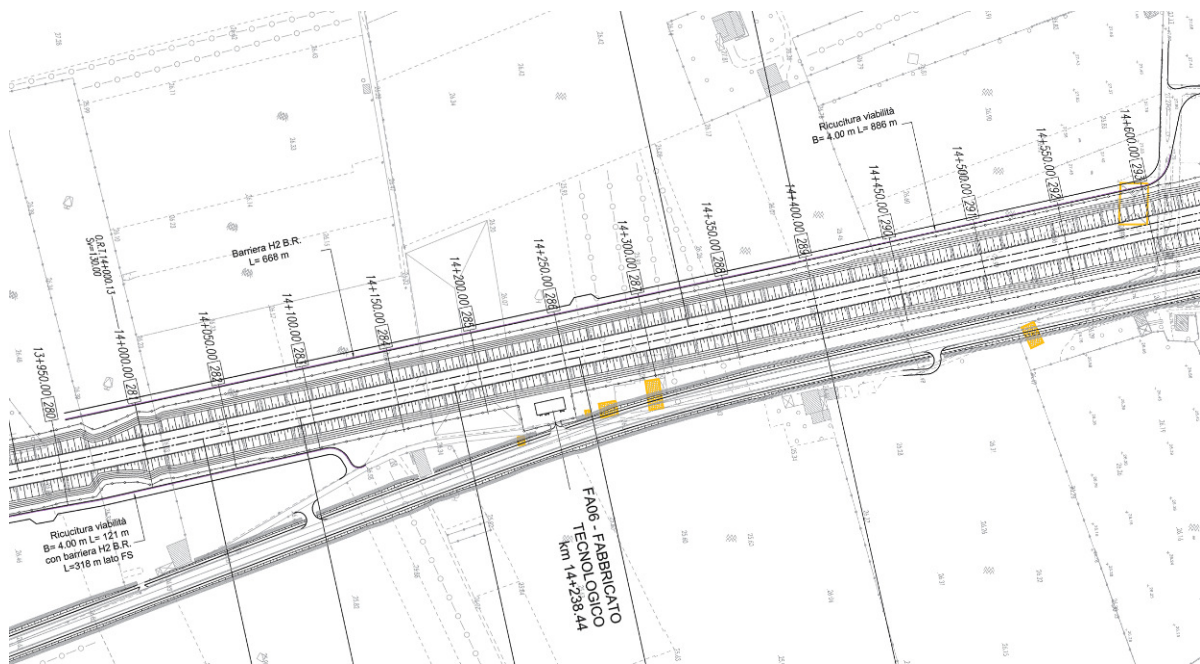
Contesto di analisi F – Progetto Esecutivo – Planimetria
